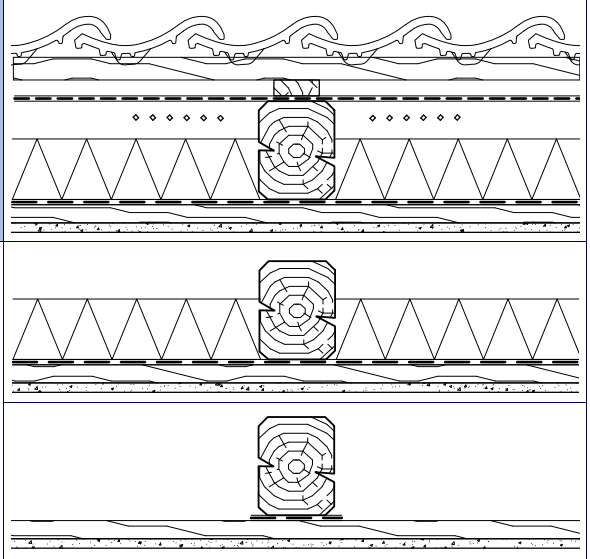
Dampfbremse einbauen – Drei Varianten
